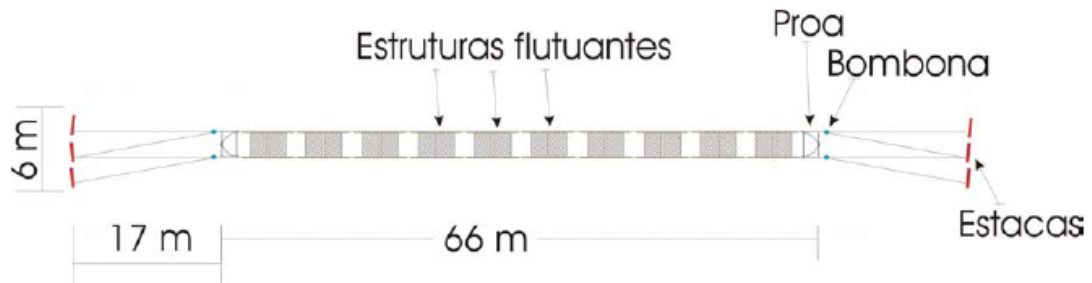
Planta baixa da armação das estruturas em pé-de-galinha
